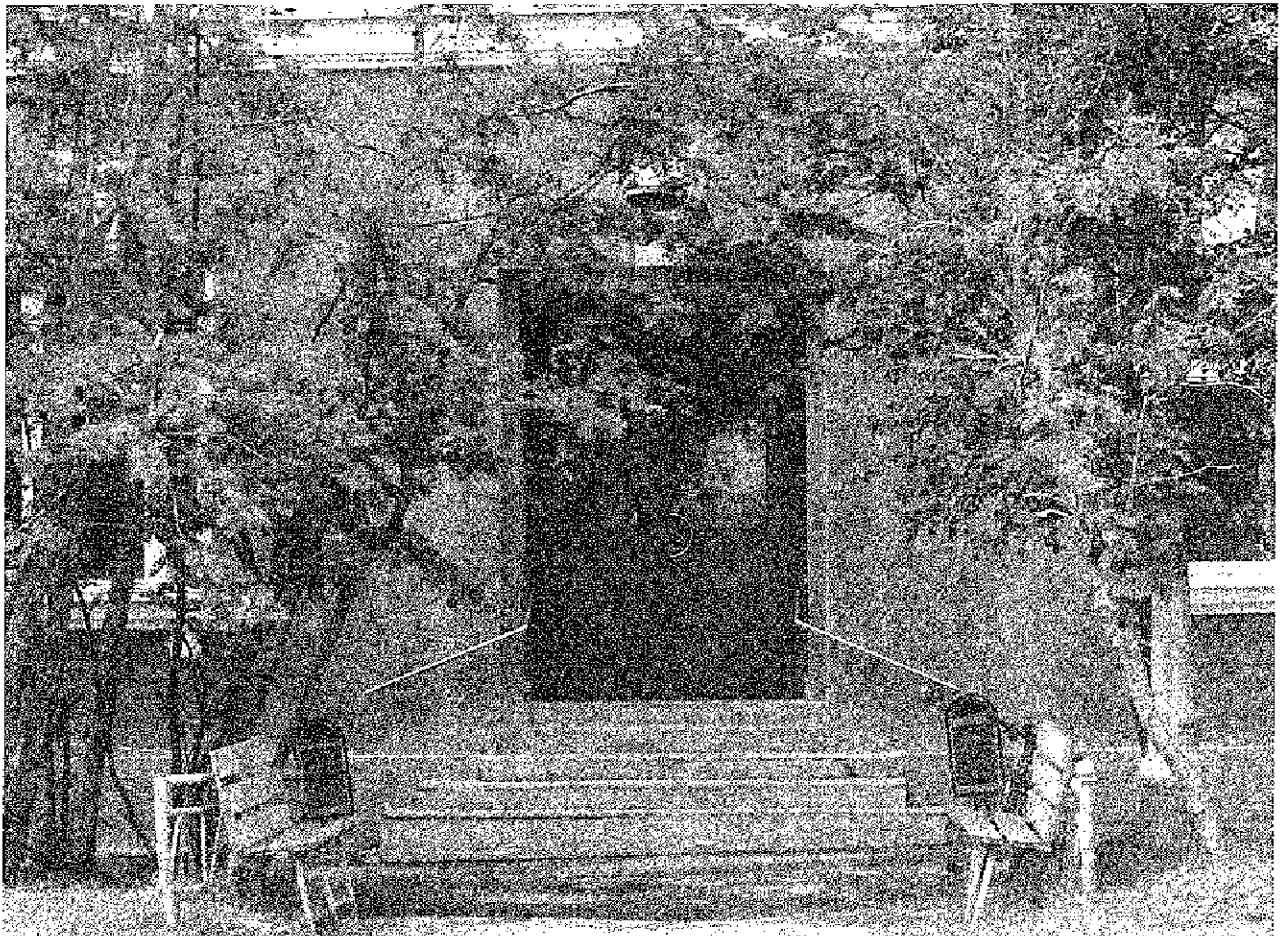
Дверной проем в центральной части южного фасада здания. Дата: 14.07.2021
